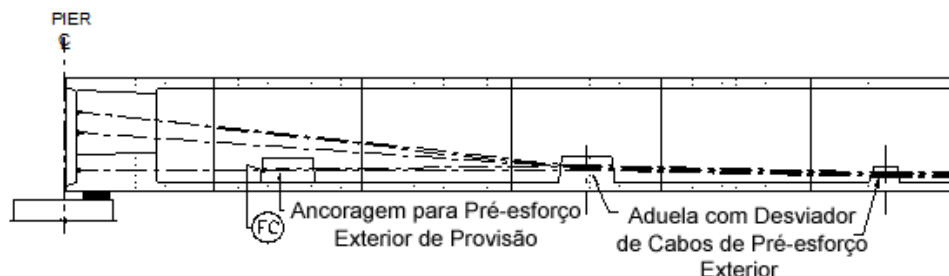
Corte longitudinal onde se esquematiza o traçado de um sistema de cabos de pré-esforço exterior não aderente.
